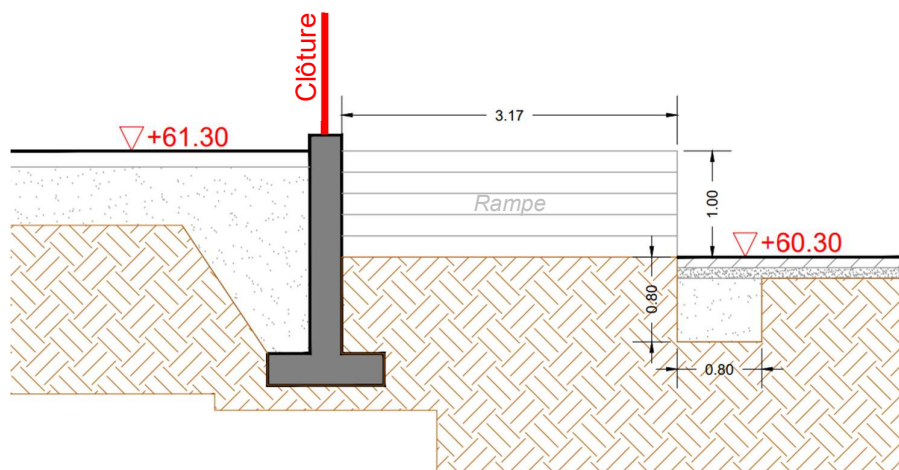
Coupe-type FF sur la zone 4 [R 3]
